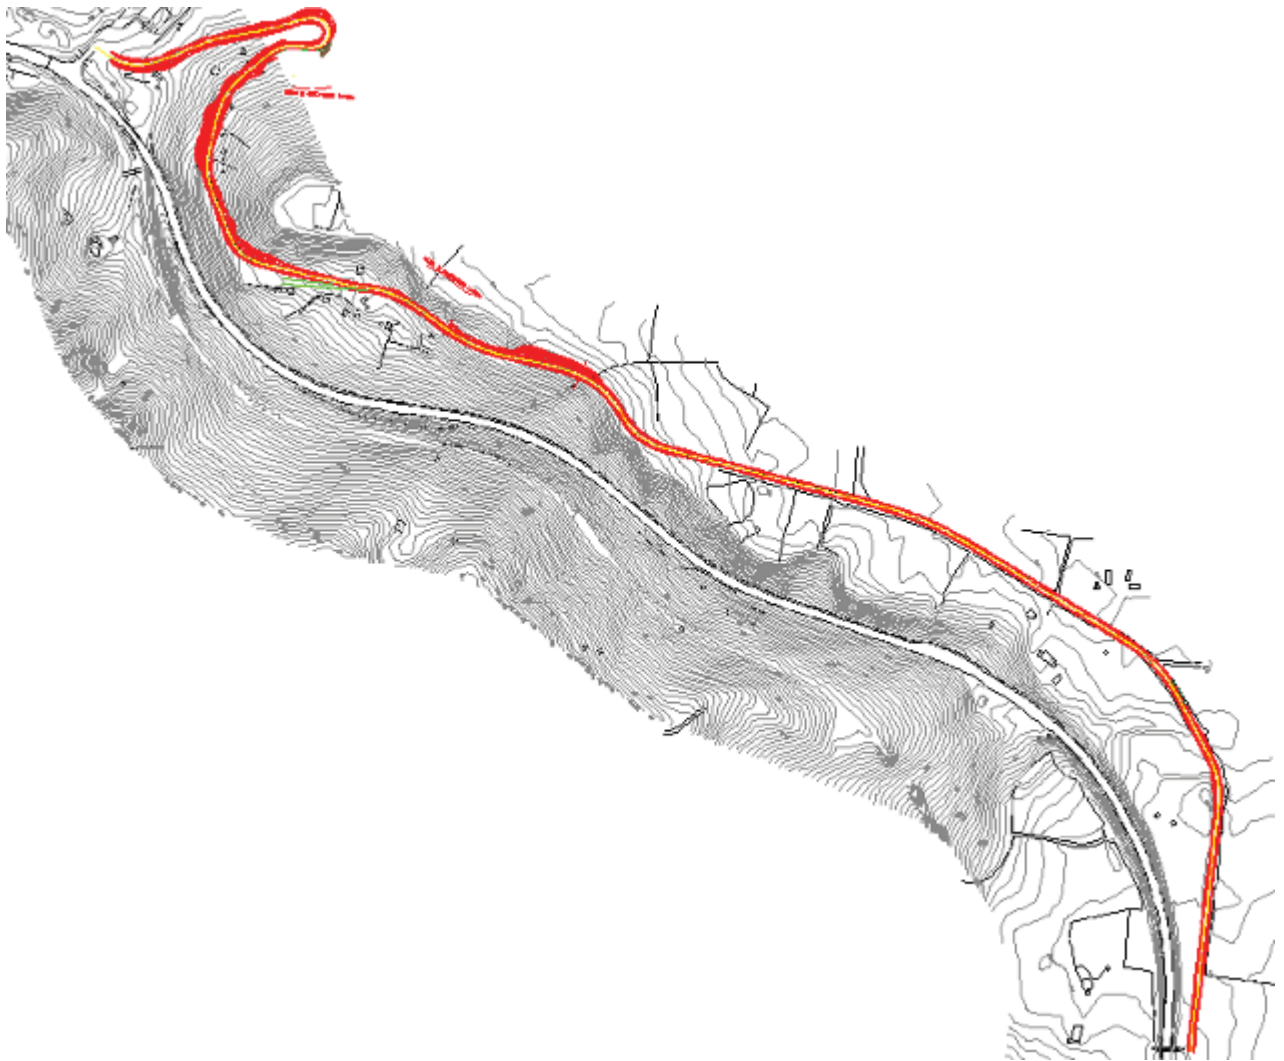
Planimetria del tratto di SP125 interessato dalla riqualificazione in sede
